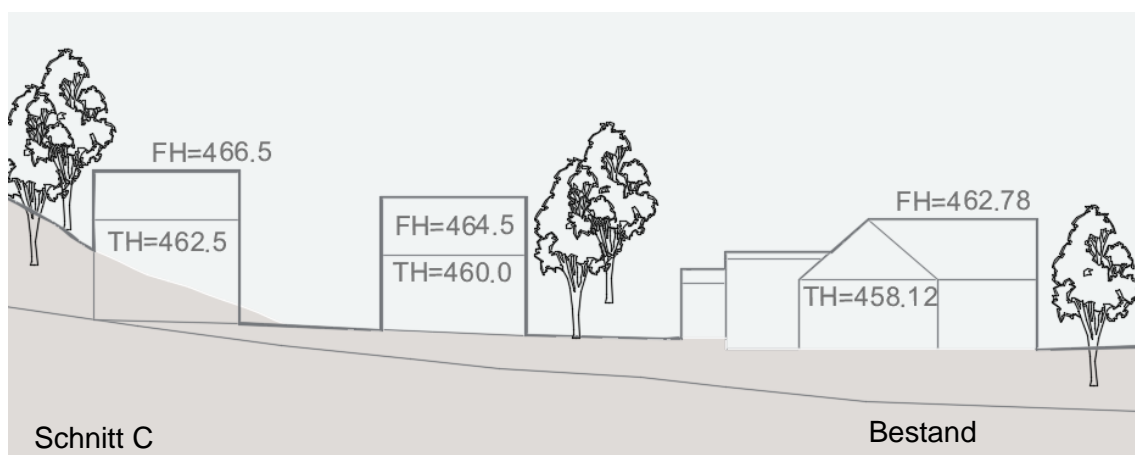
Schnitt C, schematische Darstellung einer möglichen Bebauung mit Satteldächern (Quelle: eigene Darstellung)
